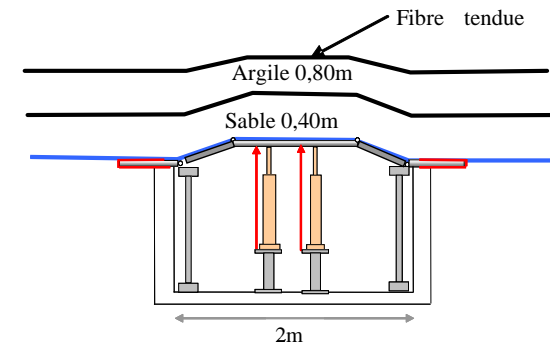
Présentation de l'essai de soulèvement sur site d'après Camp (2008).
